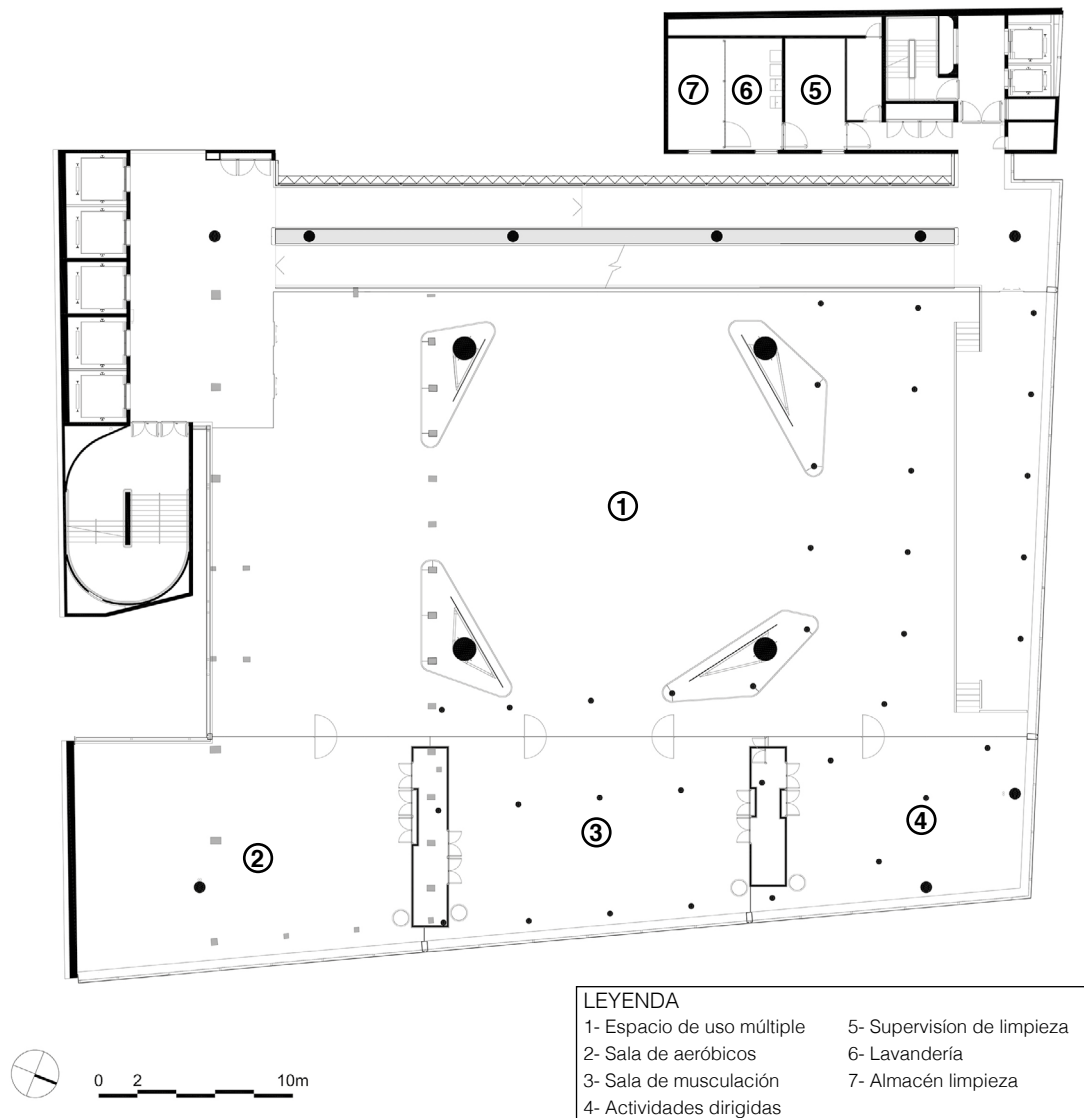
Planta Décima del Sesc 24 de Maio. (Autoría propia. 2021. Base: MMBB Arquitetos).
